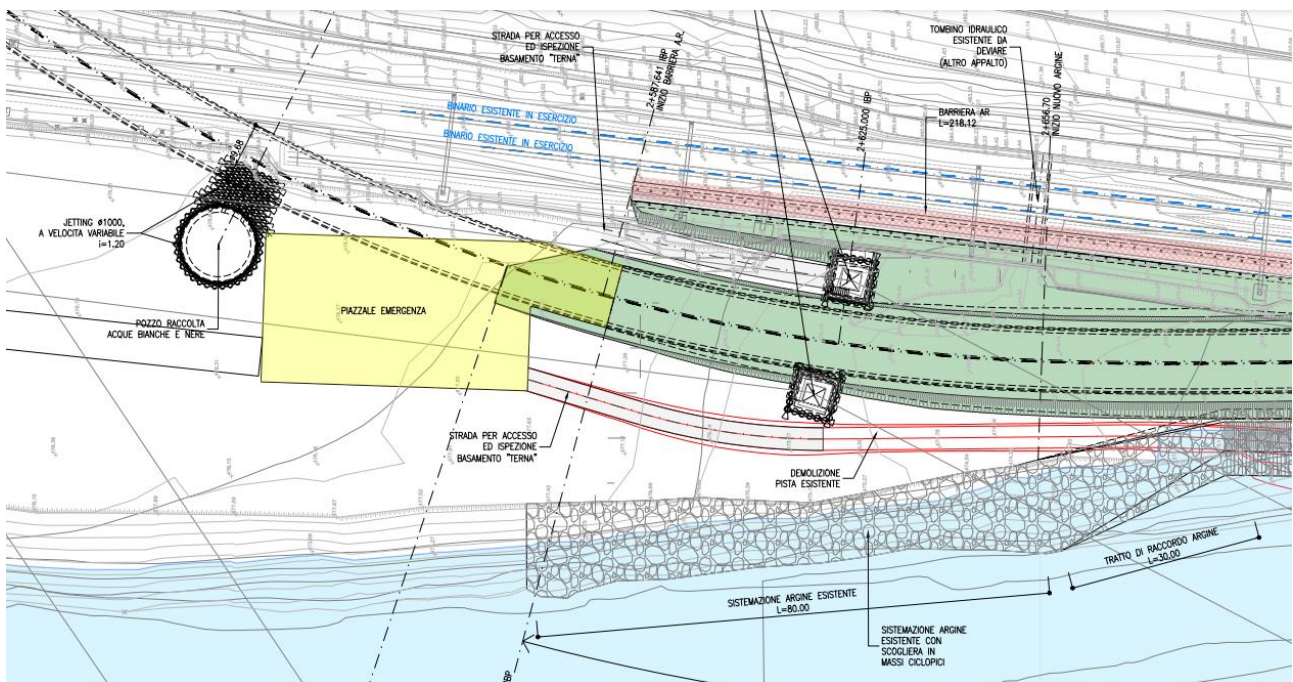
Stalcio planimetrico di IB0U1BEZZL8GA0800002C
